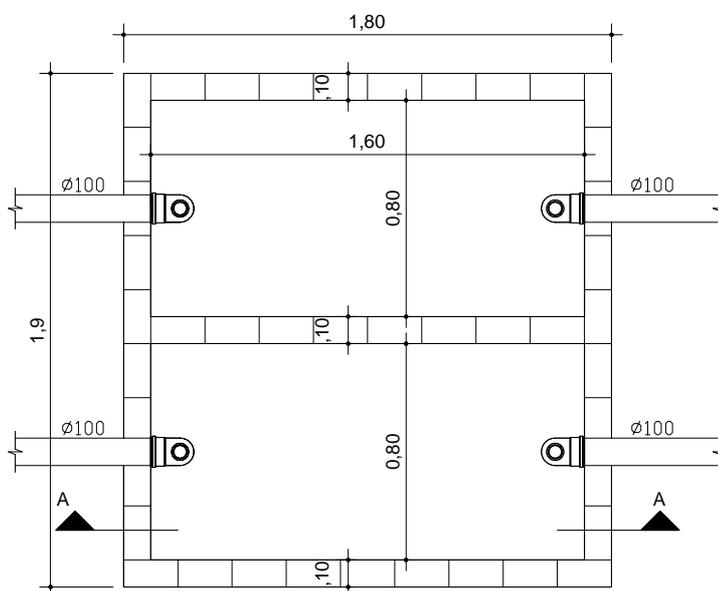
Planta baixa do tanque séptico prismático, em alvenaria de tijolo maciço. *Dimensões em metros (m).
